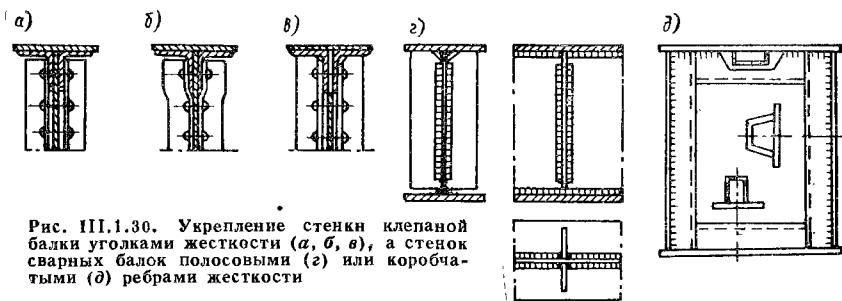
Укрепление стенок клепаной балки уголками жесткости (а, б, в), а стенок сварных балок полосовыми (з) или коробчатыми (д) ребрами жесткости
